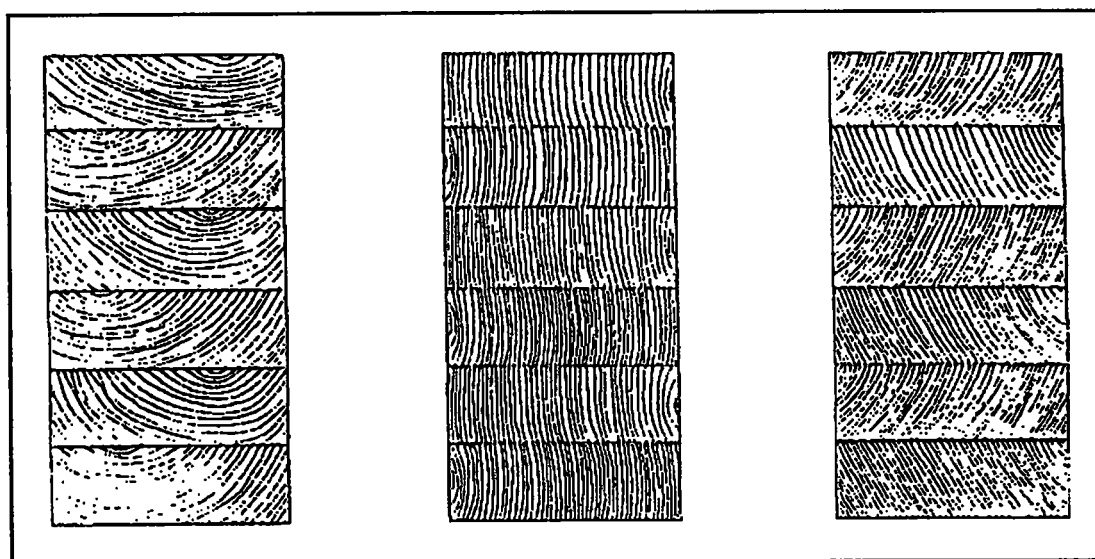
Agencement idéal des lamelles de bois dans la section des poutres lamellées-collées.
